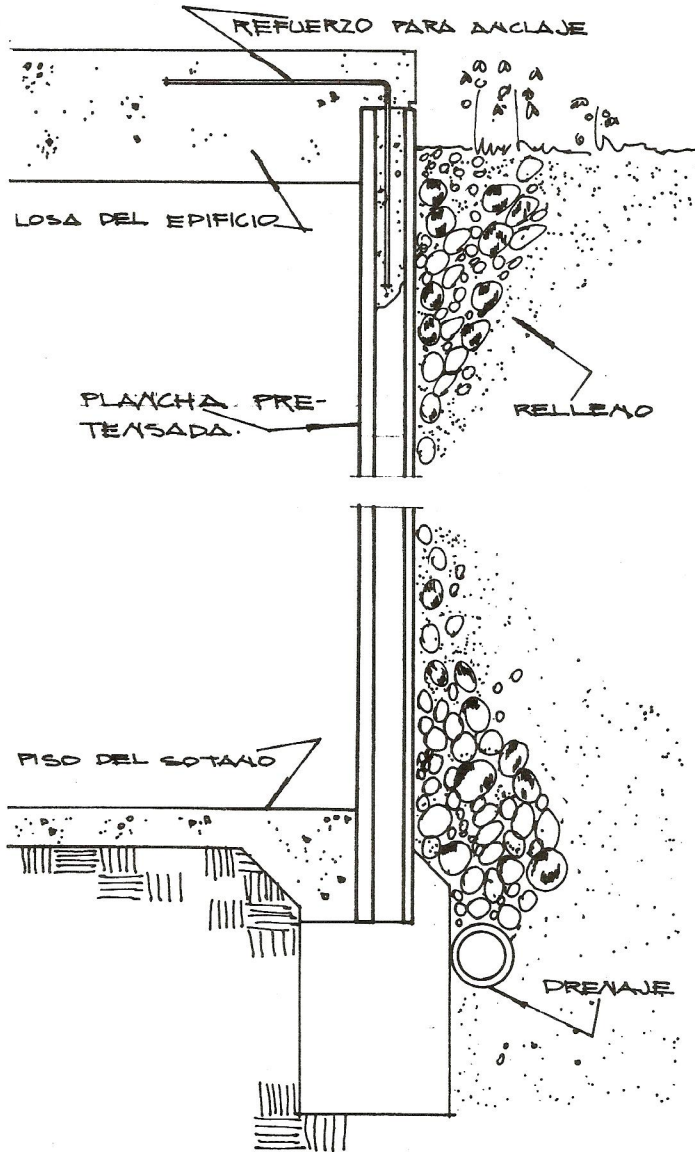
Muro de contención con planchas pretensadas apoyadas en la losa y en un cimiento especial.
